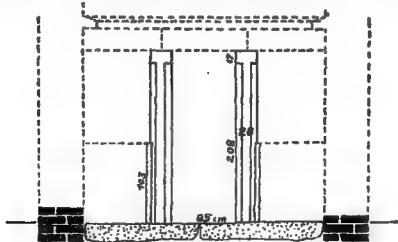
Élévation reconstituée du porche au fond de la cour.
